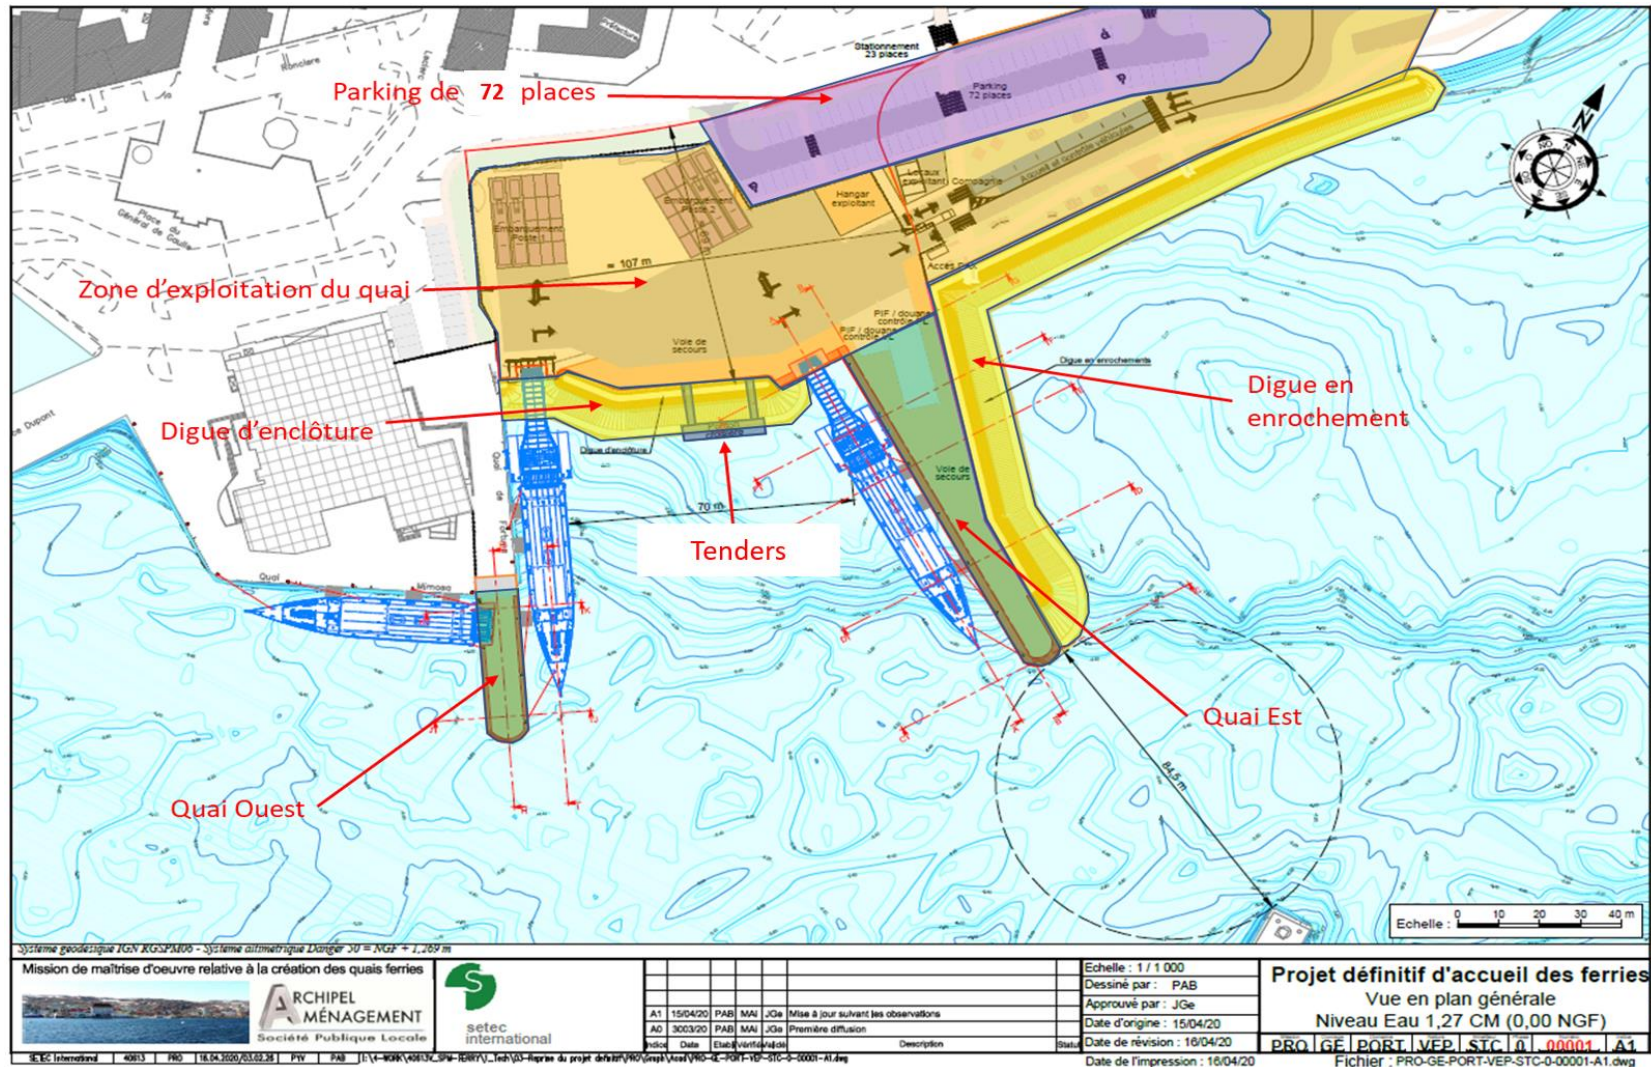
Plan général (vue en plan) du projet d'accueil des ferries (source : setec international, 2020)
